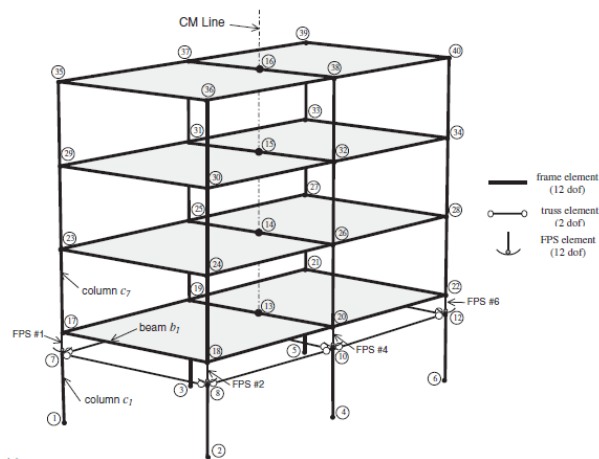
Modello strutturale di riferimento (Almazan et al. 2003)
